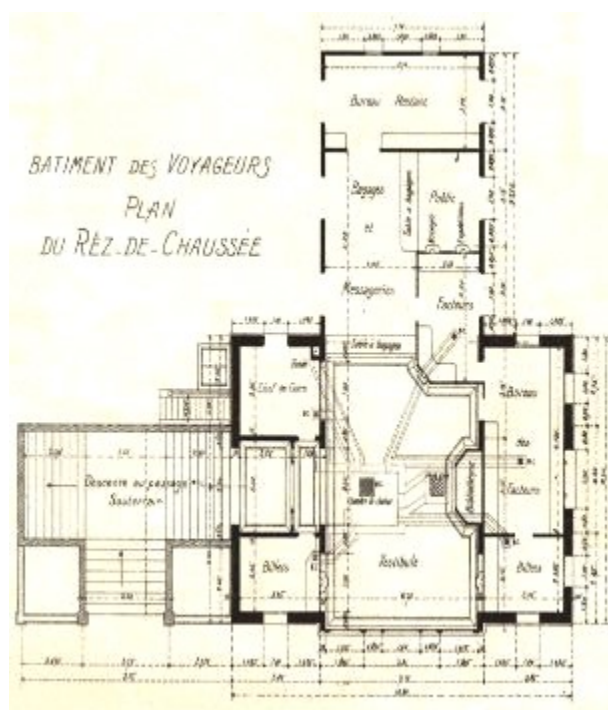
Plan du Rez-de-chaussée du bâtiment voyageur
